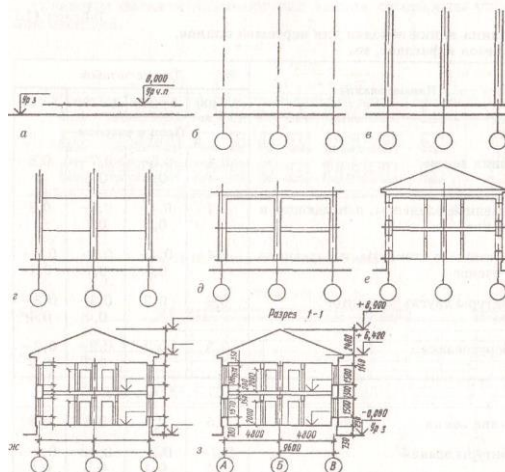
Пример выполнения поперечного архитектурного разреза гражданского здания с несущими продольными стенами
